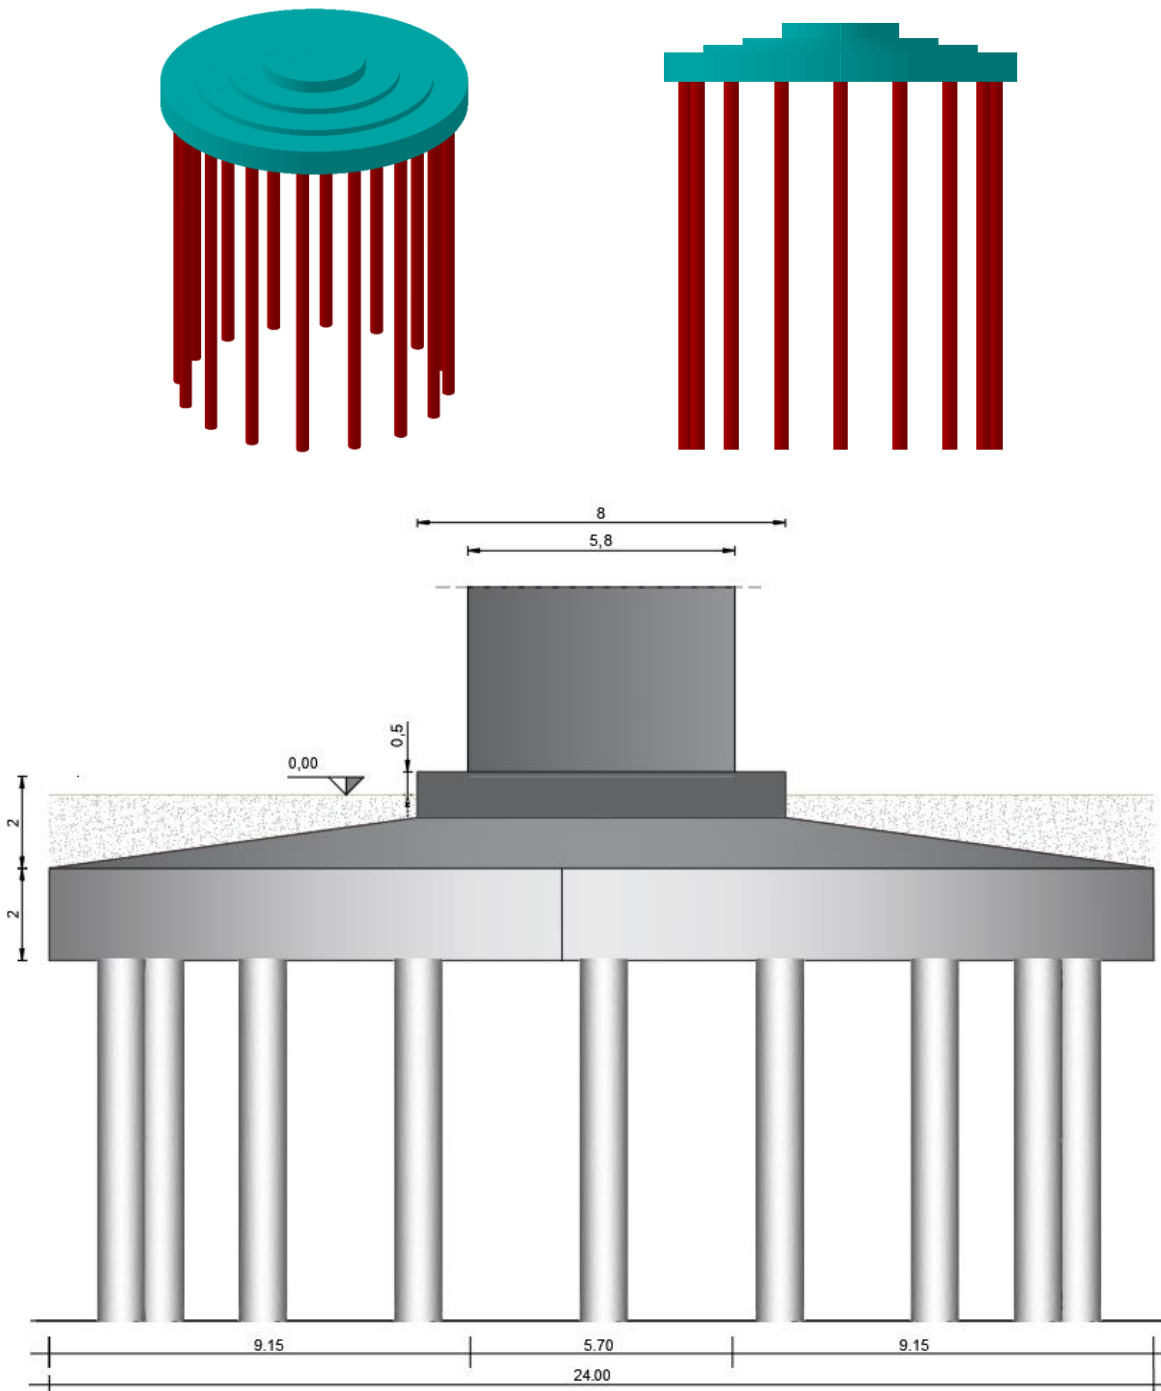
Vista 3D e vista XZ fondazione tipo, in alto, e schema geometrico di riferimento della struttura di fondazione, in basso.
